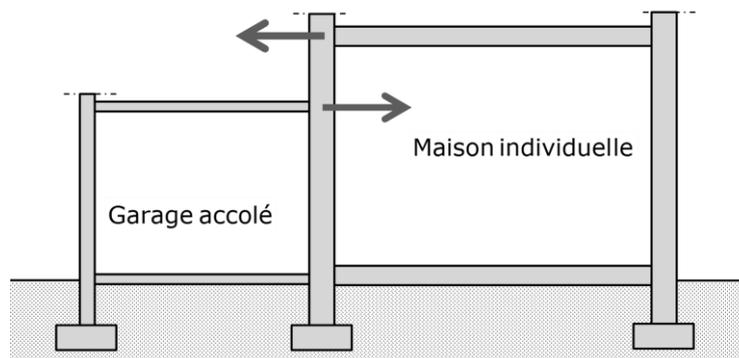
exemple de sollicitations supplémentaires sur la maison individuelle accolée à un garage
